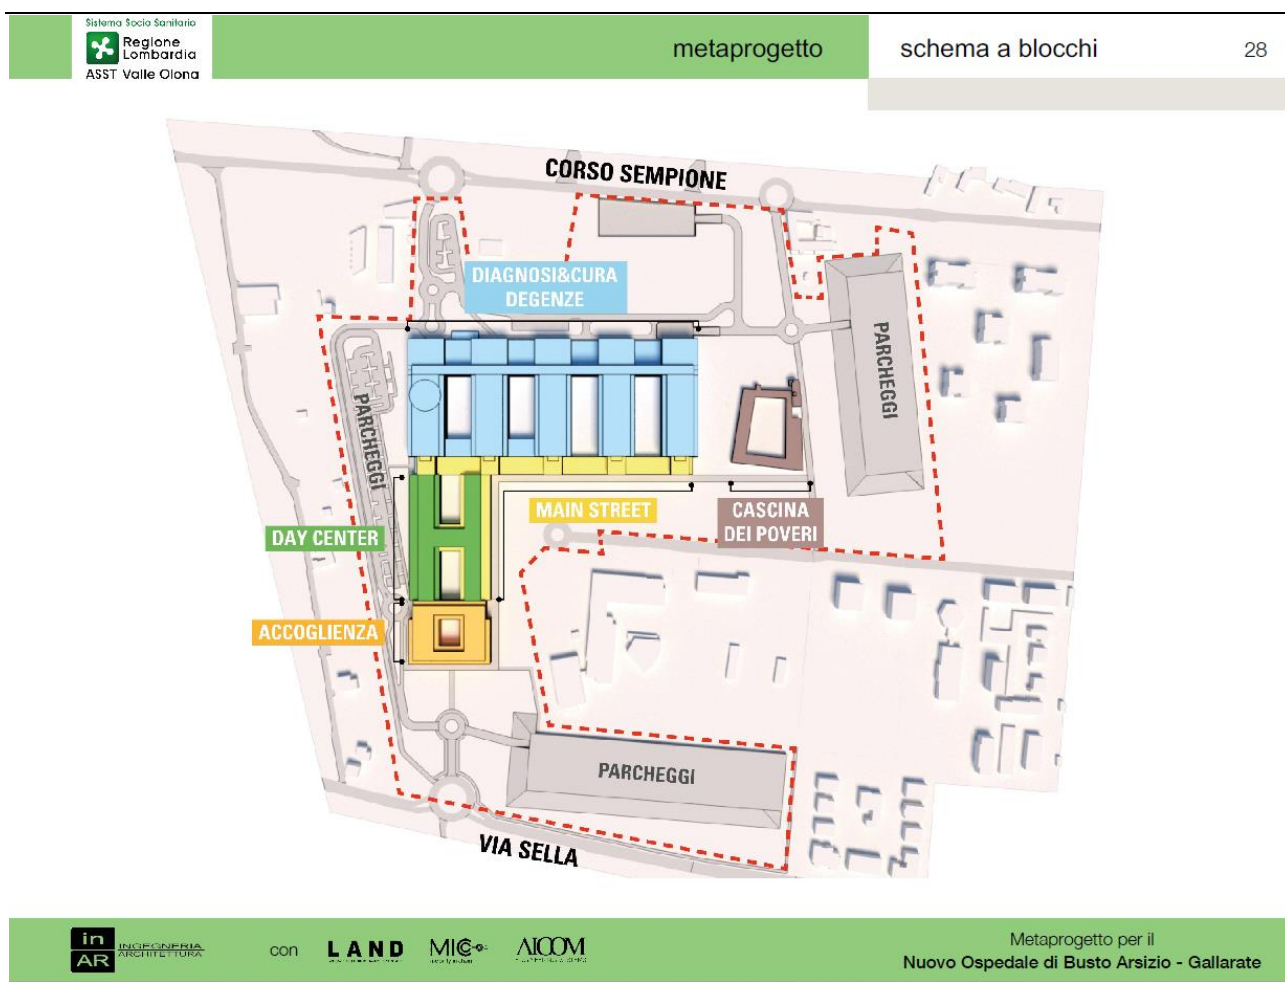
Metaprogetto: schema planimetrico con individuazione dei blocchi funzionali
